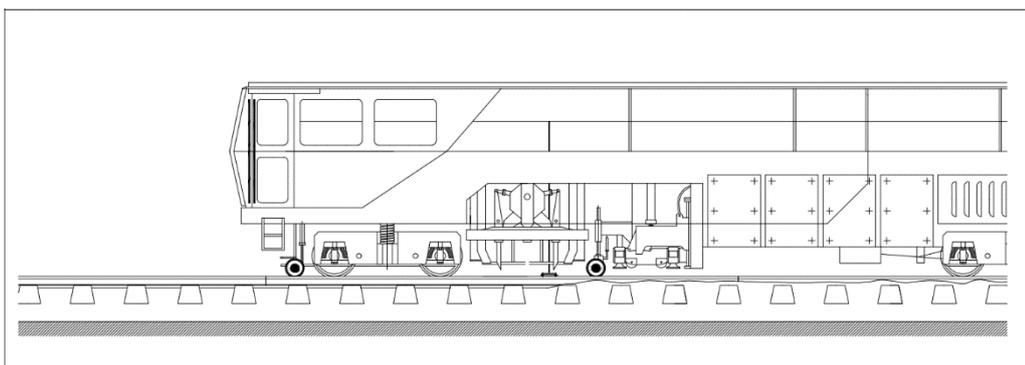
Bateo, perfilado y alineado de balasto y vía [Fuente: elaboración propia]
